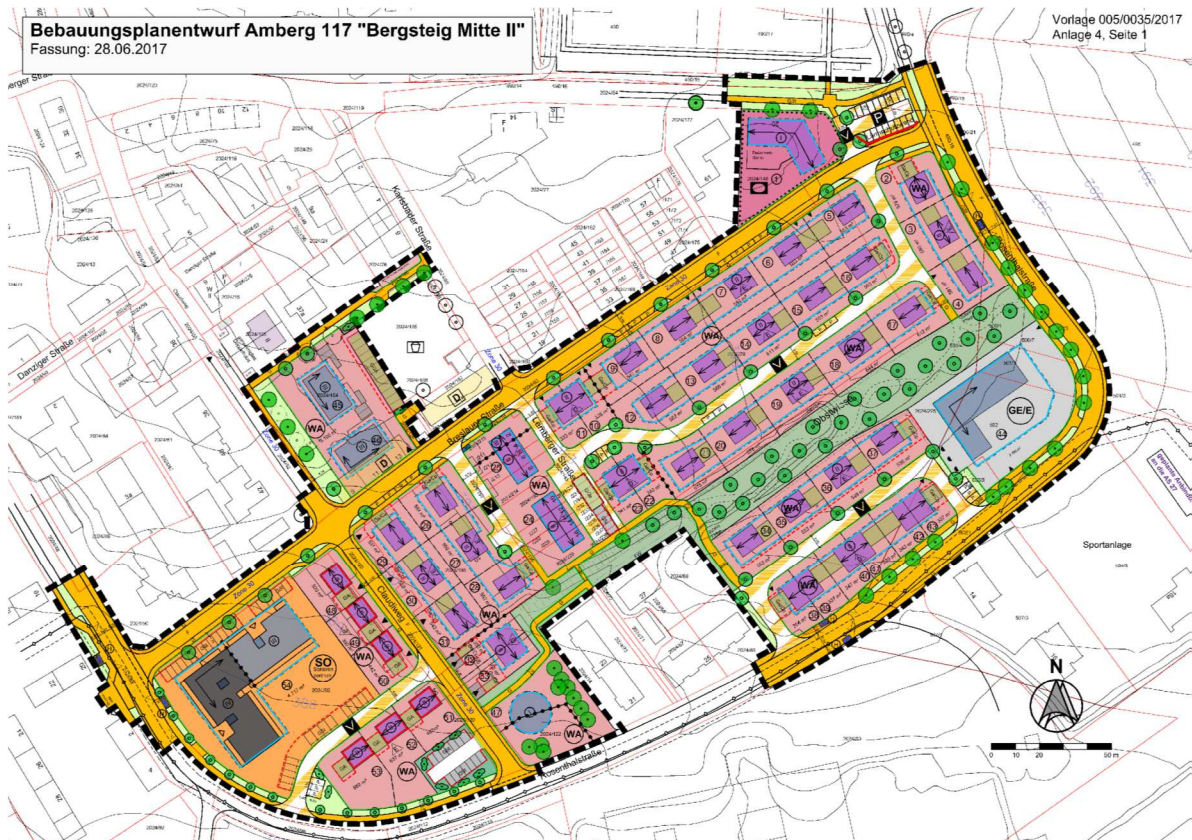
Bebauungsplanentwurf Stand: 28.06.2017
